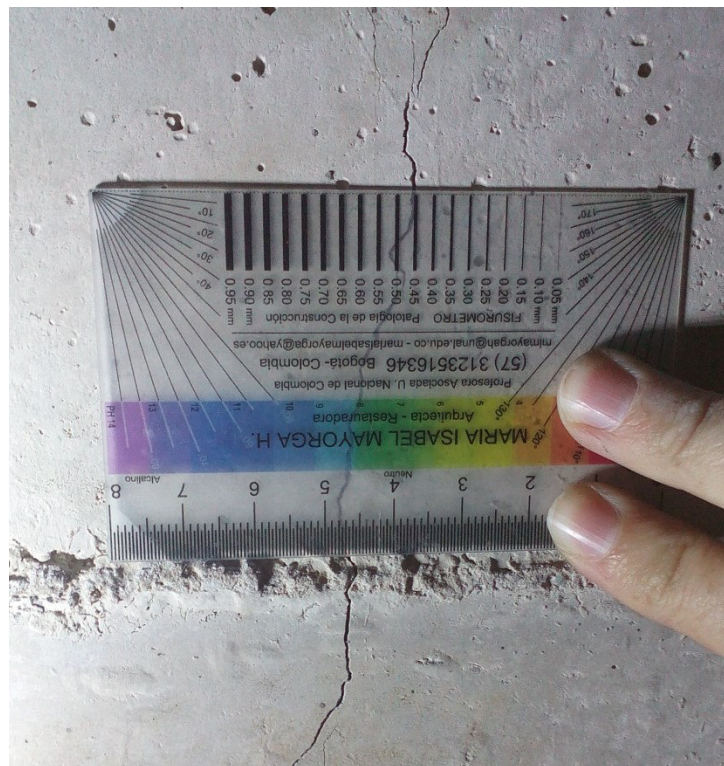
Medición de la fisuración en muro de contención sótano 1
